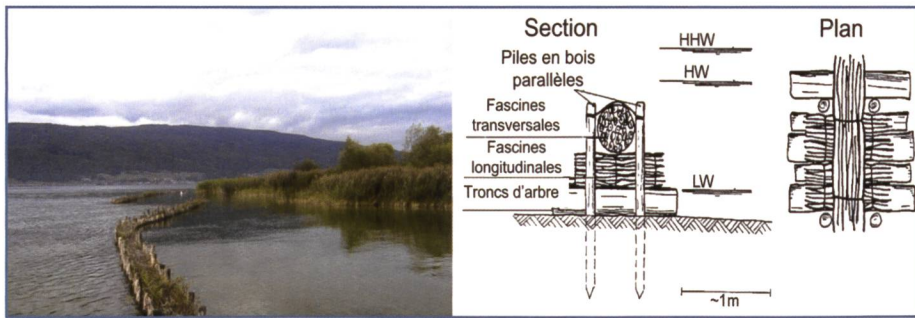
Implantation et construction de barrages à claire-voie sur le lac de Biene.
